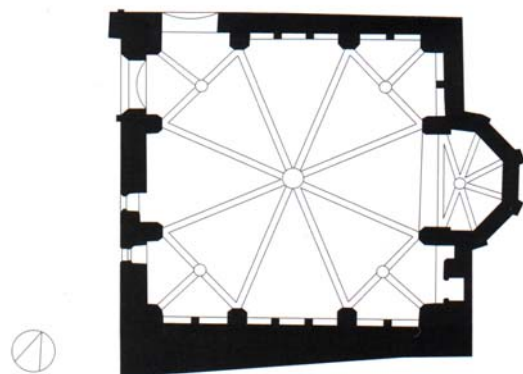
Krems, Gozzoburg, Grundriss
